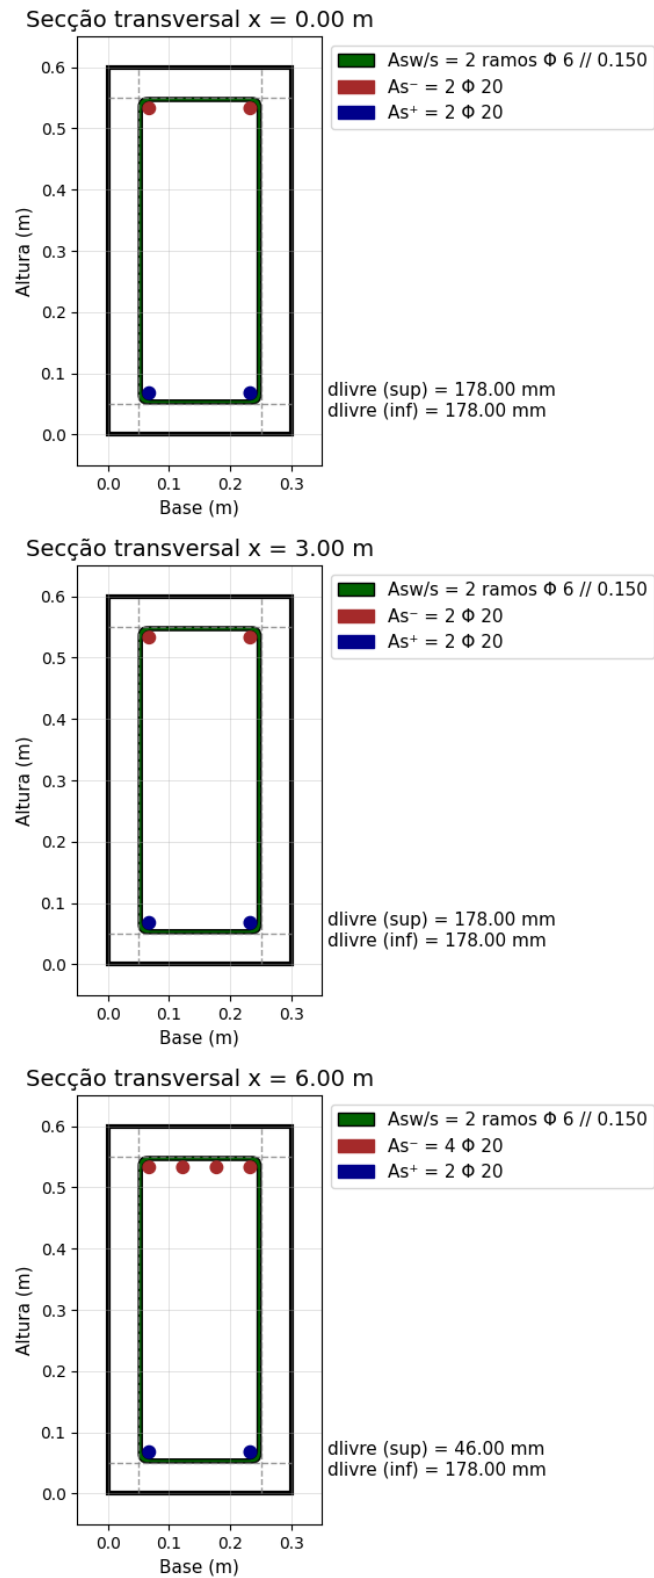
Exemplos de cortes transversais da viga com as disposições de armaduras adotadas em várias secções
